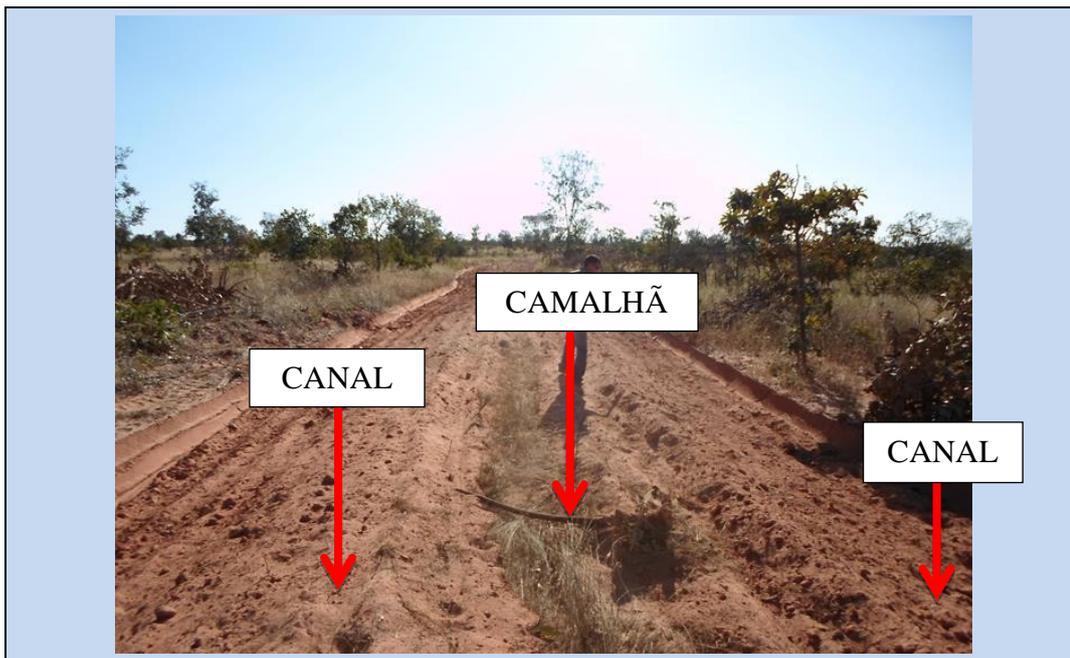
Terraceador e elementos do terraço executados na BHSF.
